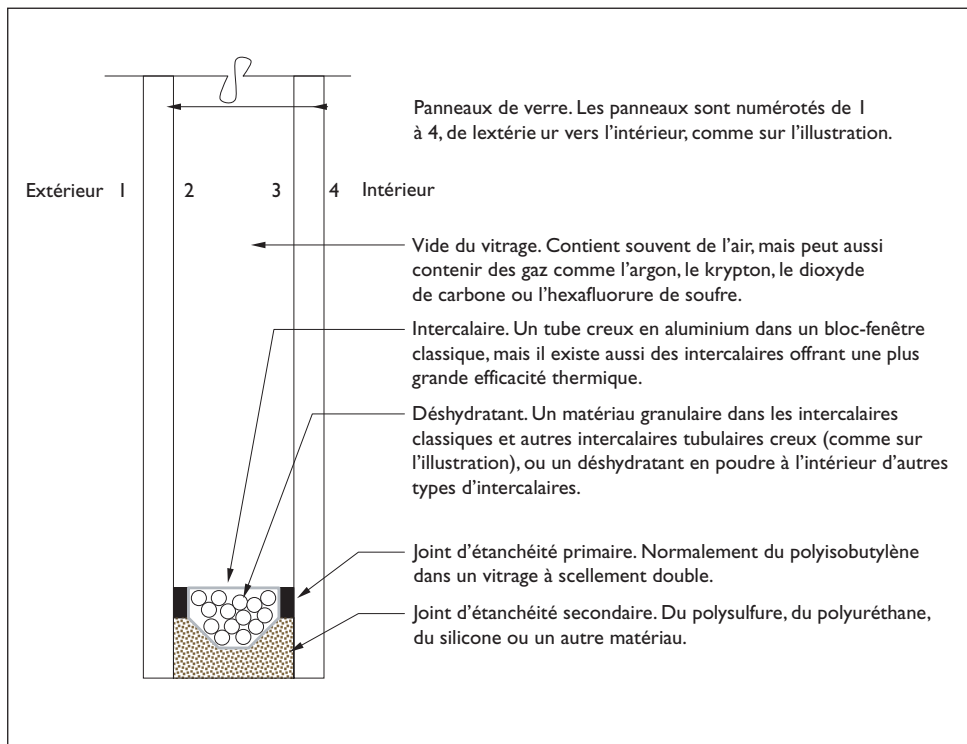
Coupe transversale d'un vitrage isolant caractéristique
